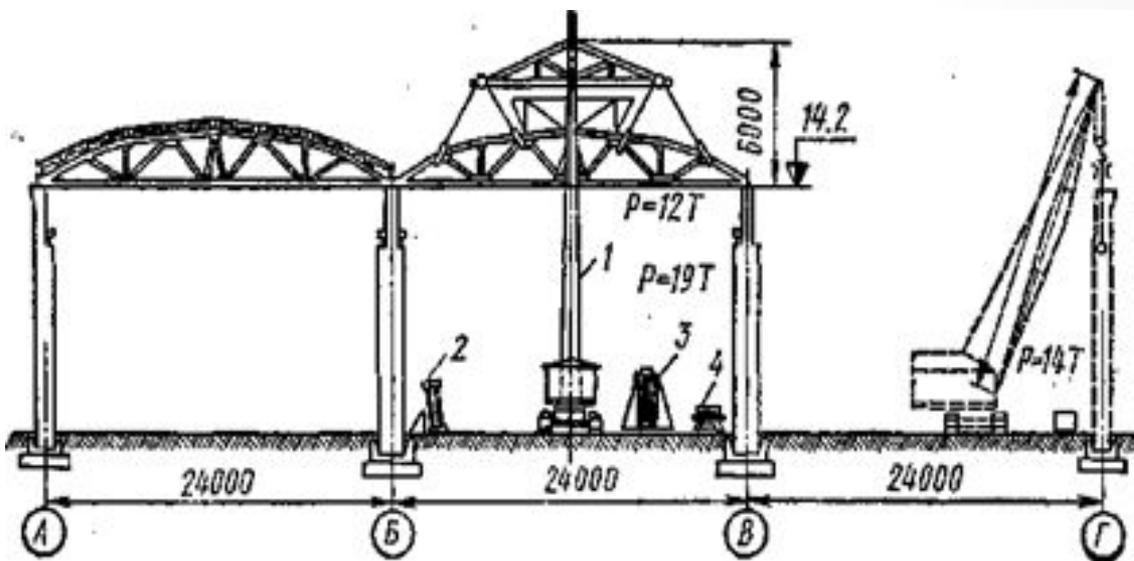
Схема монтажа цеха: 1 — кран СКГ-30 со стрелой 25 м; 2 — полуфермы; 3 — стенд для укрупнения ферм; 4 — плиты покрытия
